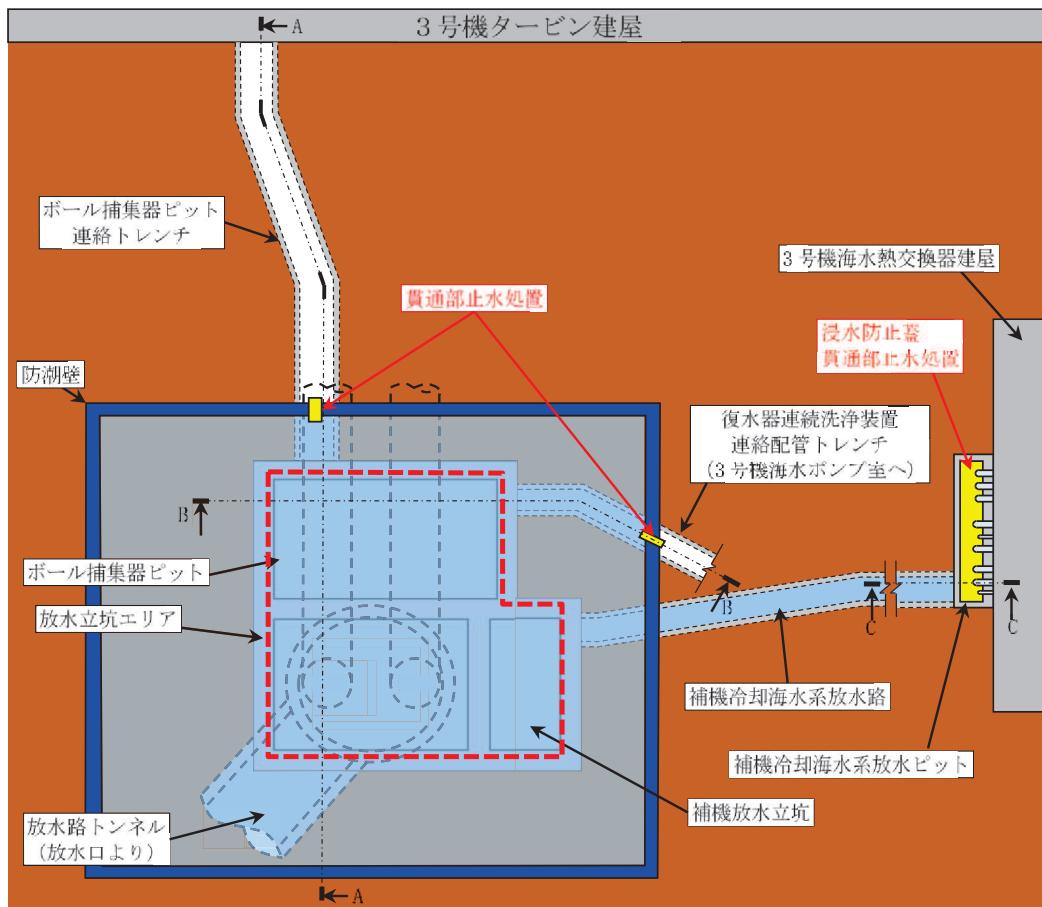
第 3 号機 放水立坑 浸水対策配置図（平面図）
